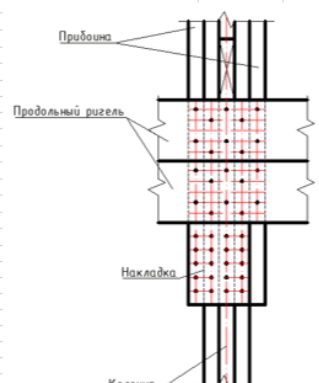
Расчет прикрепления продольного ригеля к стойке
